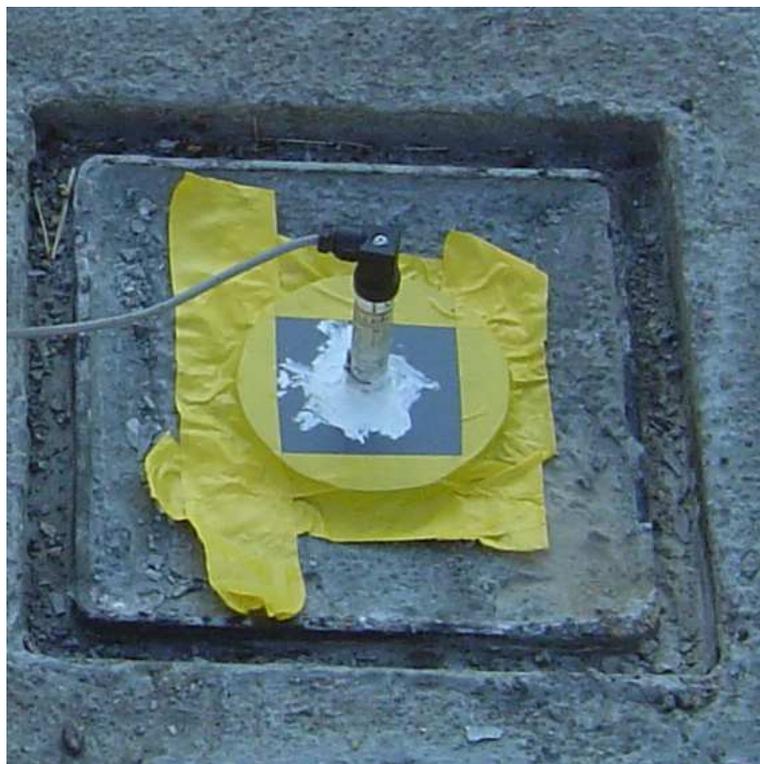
Aménagement provisoire pour mesurer la surpression en tête d'un forage soufflant débouchant vers des vieux travaux miniers.
